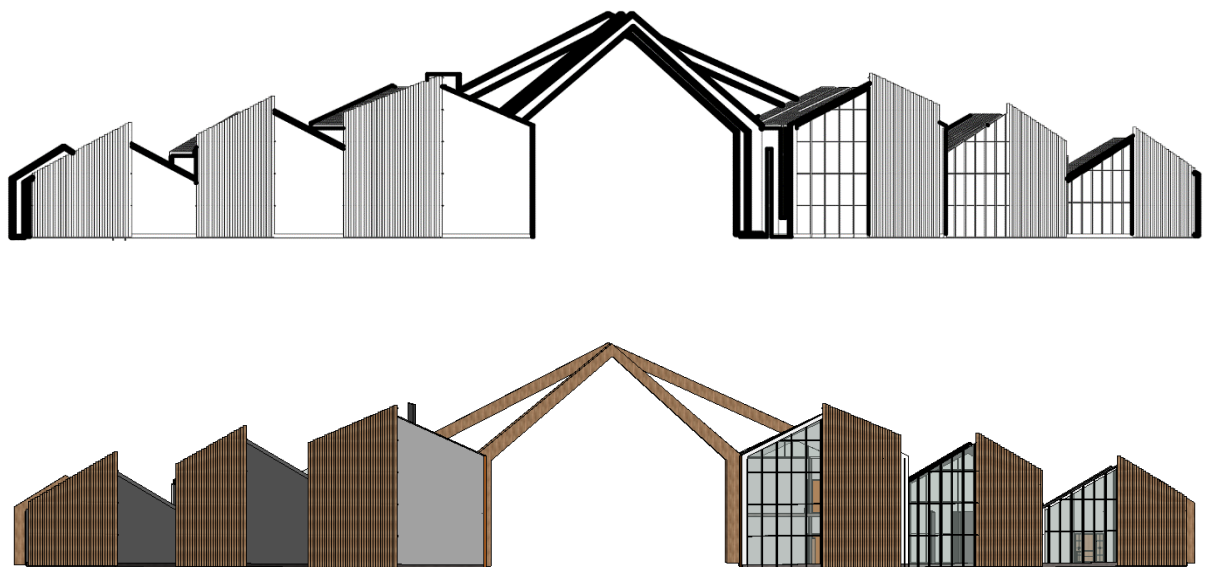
Façade secondaire du nouveau et l'ancien bâtiment
